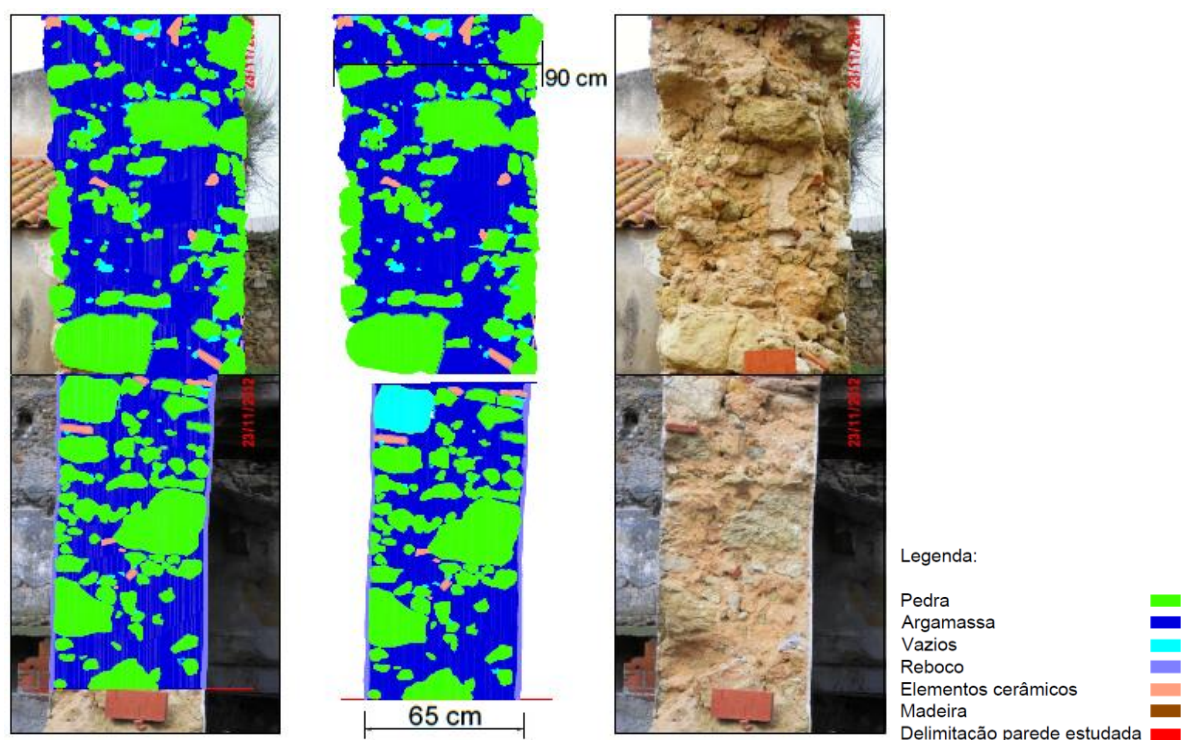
Esquemas das secções transversais da zona “Faculdade”
